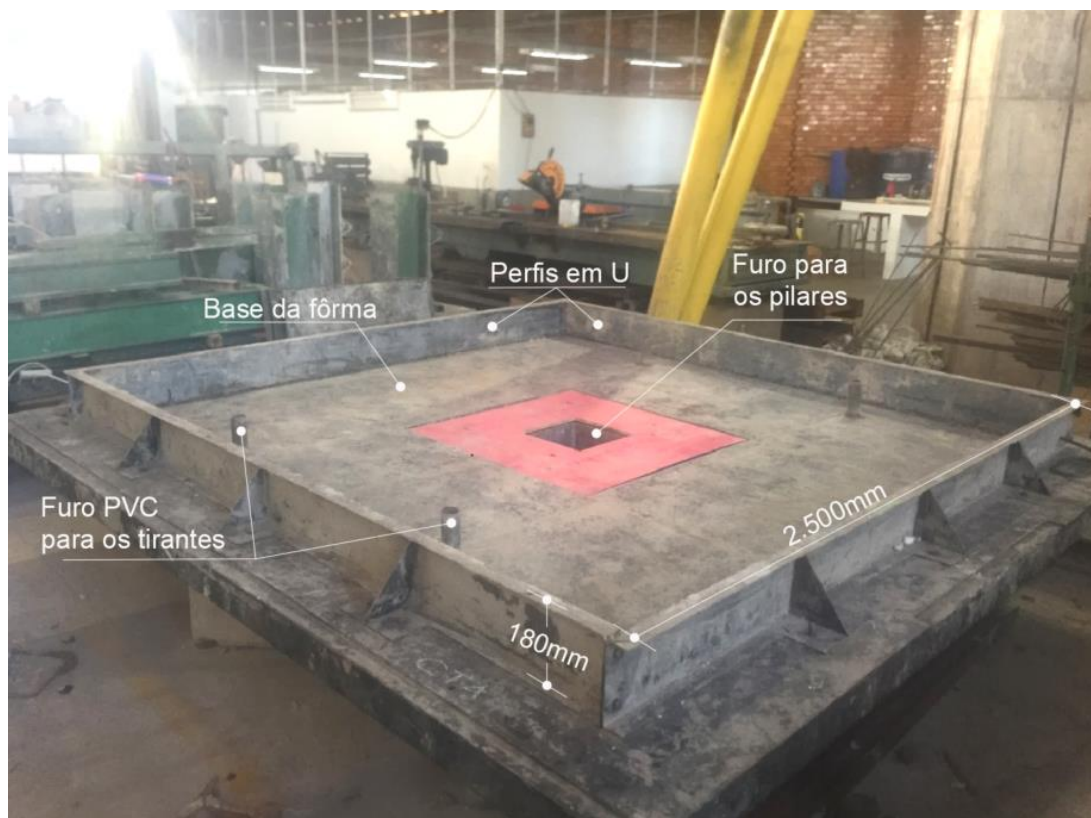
Sistema de fôrmas das lajes ensaiadas.
